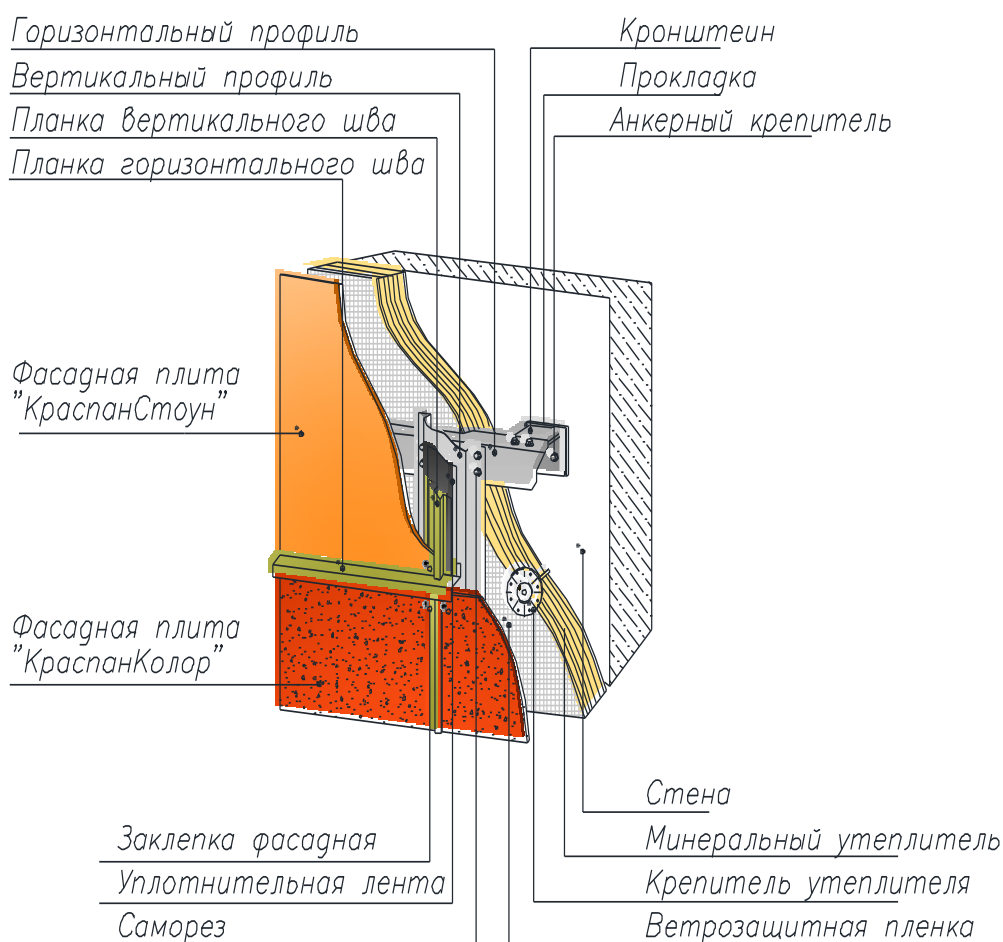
Узел крепления фасадной системы «Краспан»
